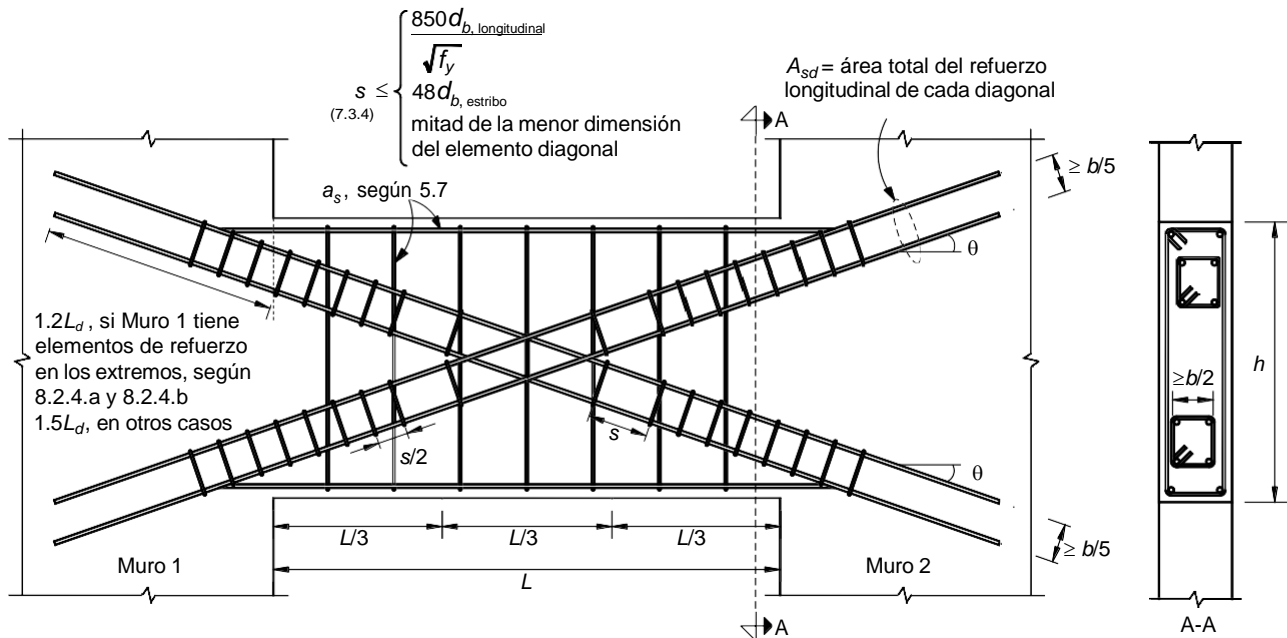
Refuerzo de una viga de gran peralte que une muros sujetos a fuerzas horizontales en su plano
